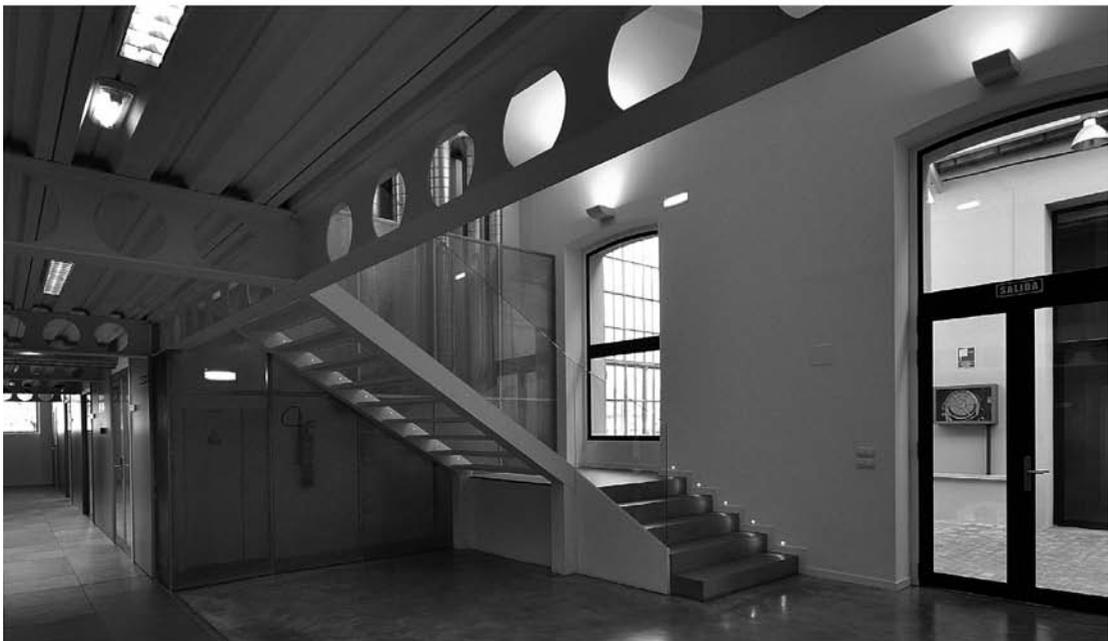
Arriba, planta primera. Foto: José Ornia.
